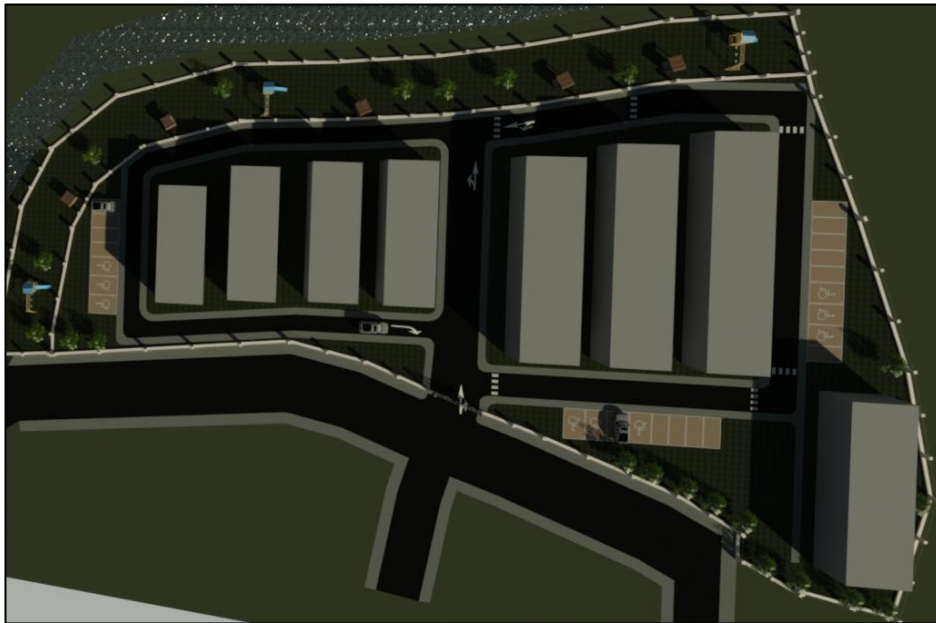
Propuesta de bloques para Sección 2 de Lote B
